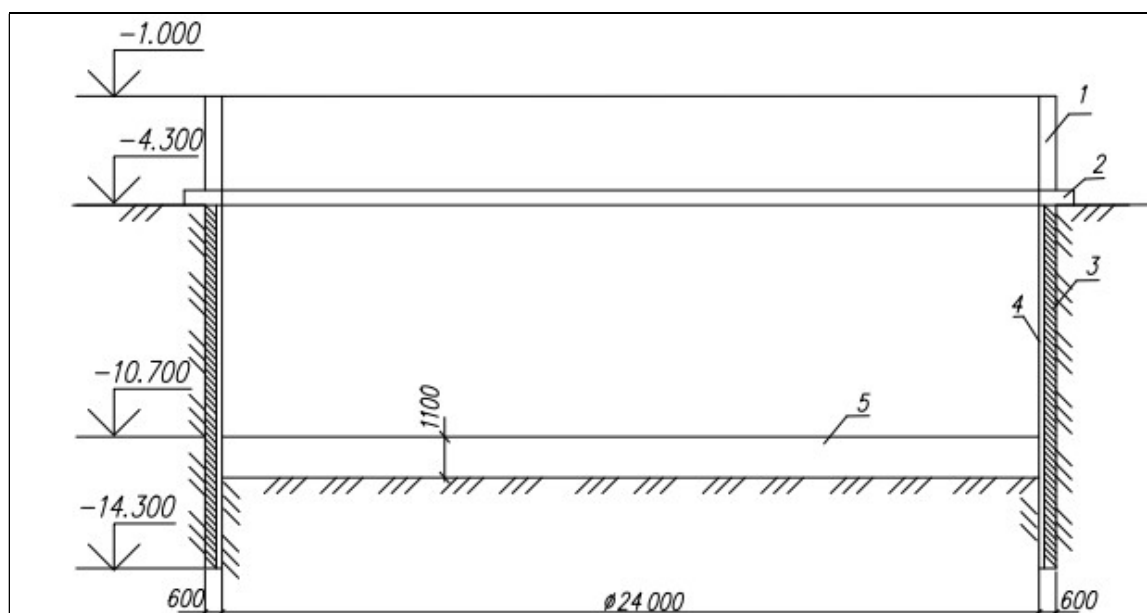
Схематический разрез подземной части КНС: 1 – стенка монолитная надземная; 2 – ростверк монолитный обвязочный; 3, 4 – монолитная и сборная части «стены в грунте» соответственно; 5 – железобетонное днище
